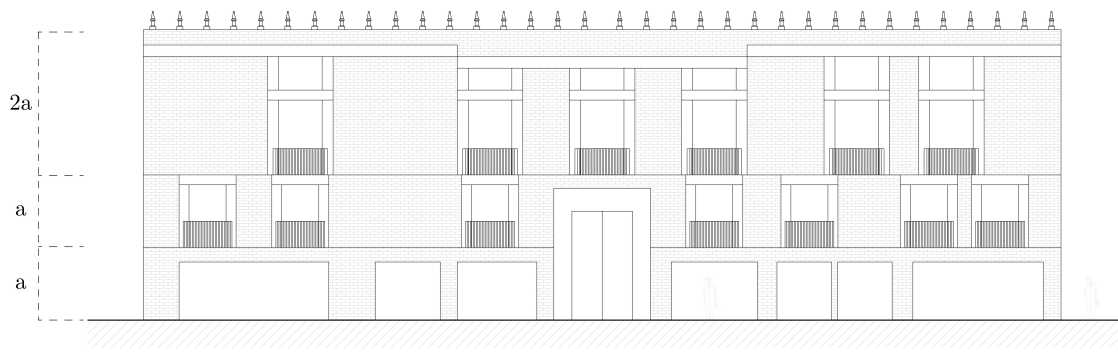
Comparación de escala y proporción en la fachada del proyecto Fuente y elaboración: Autores
